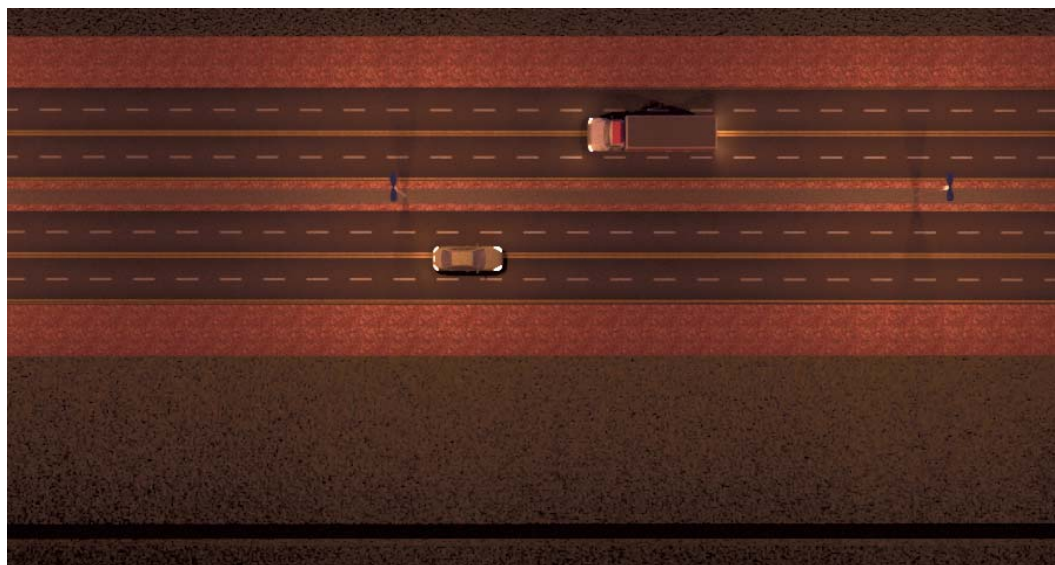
Vista en planta de la carretera tipo A4 con sistemas de iluminación.
